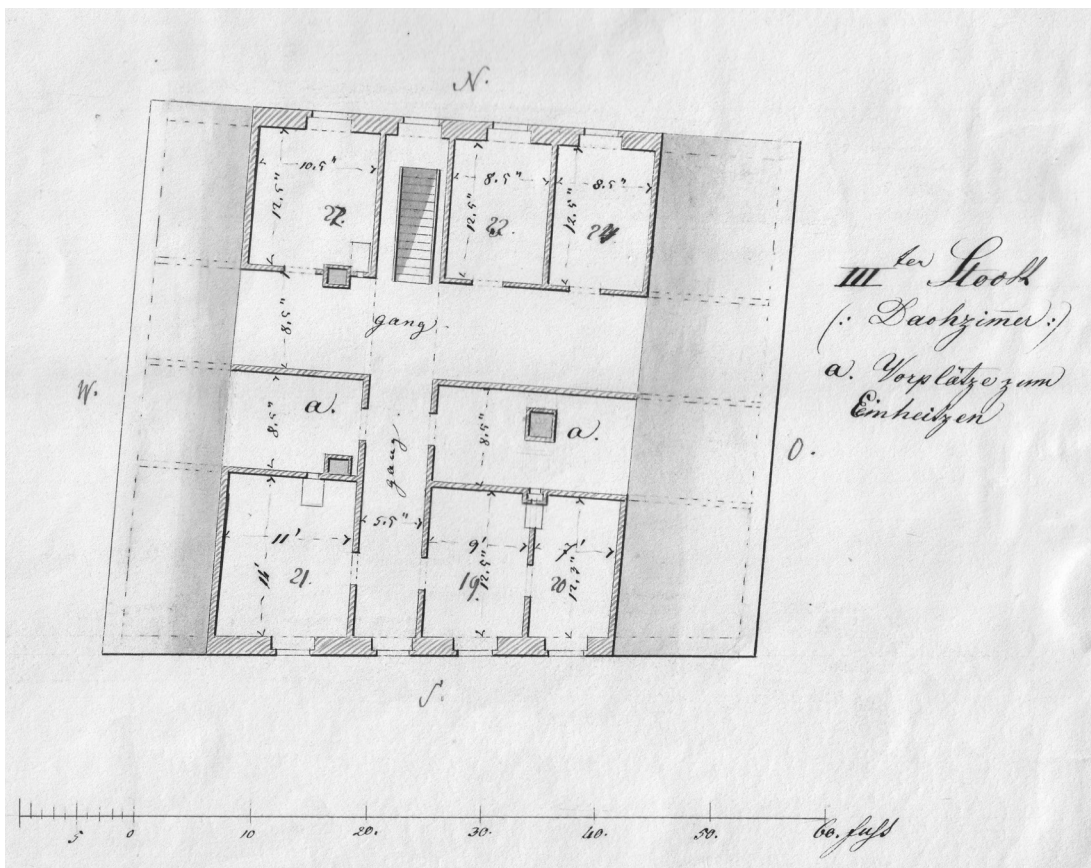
Spitalstraße 33, Grundriss 1. Dachgeschoss im Jahr 1846.
